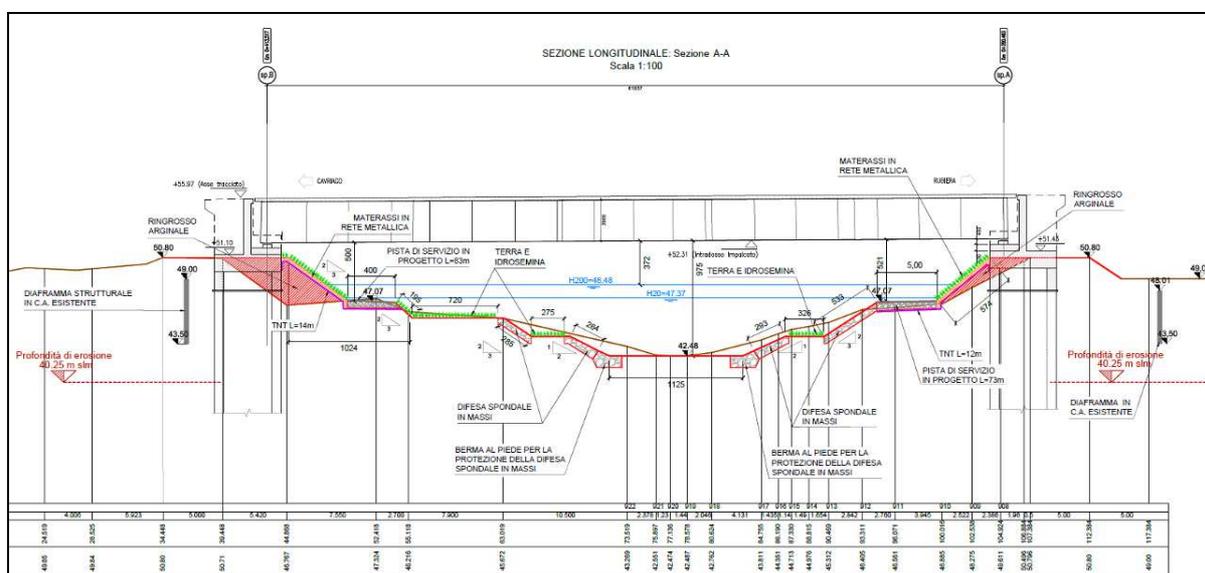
PONTE IN PROGETTO SUL TORRENTE CROSTOLO
